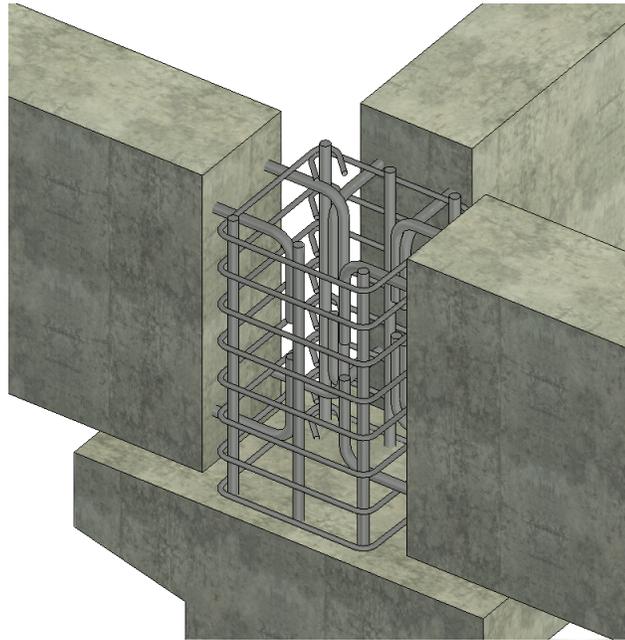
Empalme pilar central. Fuente: Elaboración propia.
